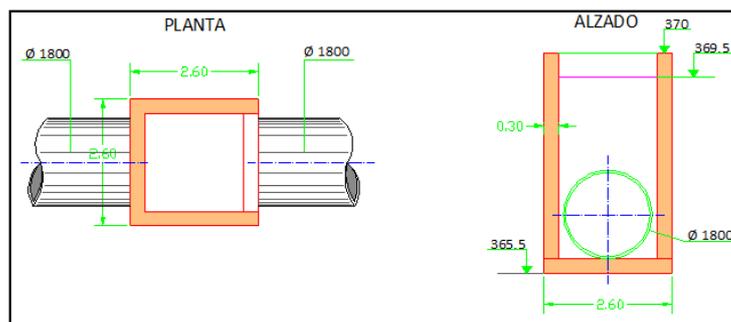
Planta y alzado de la arqueta/aliviadero final.
